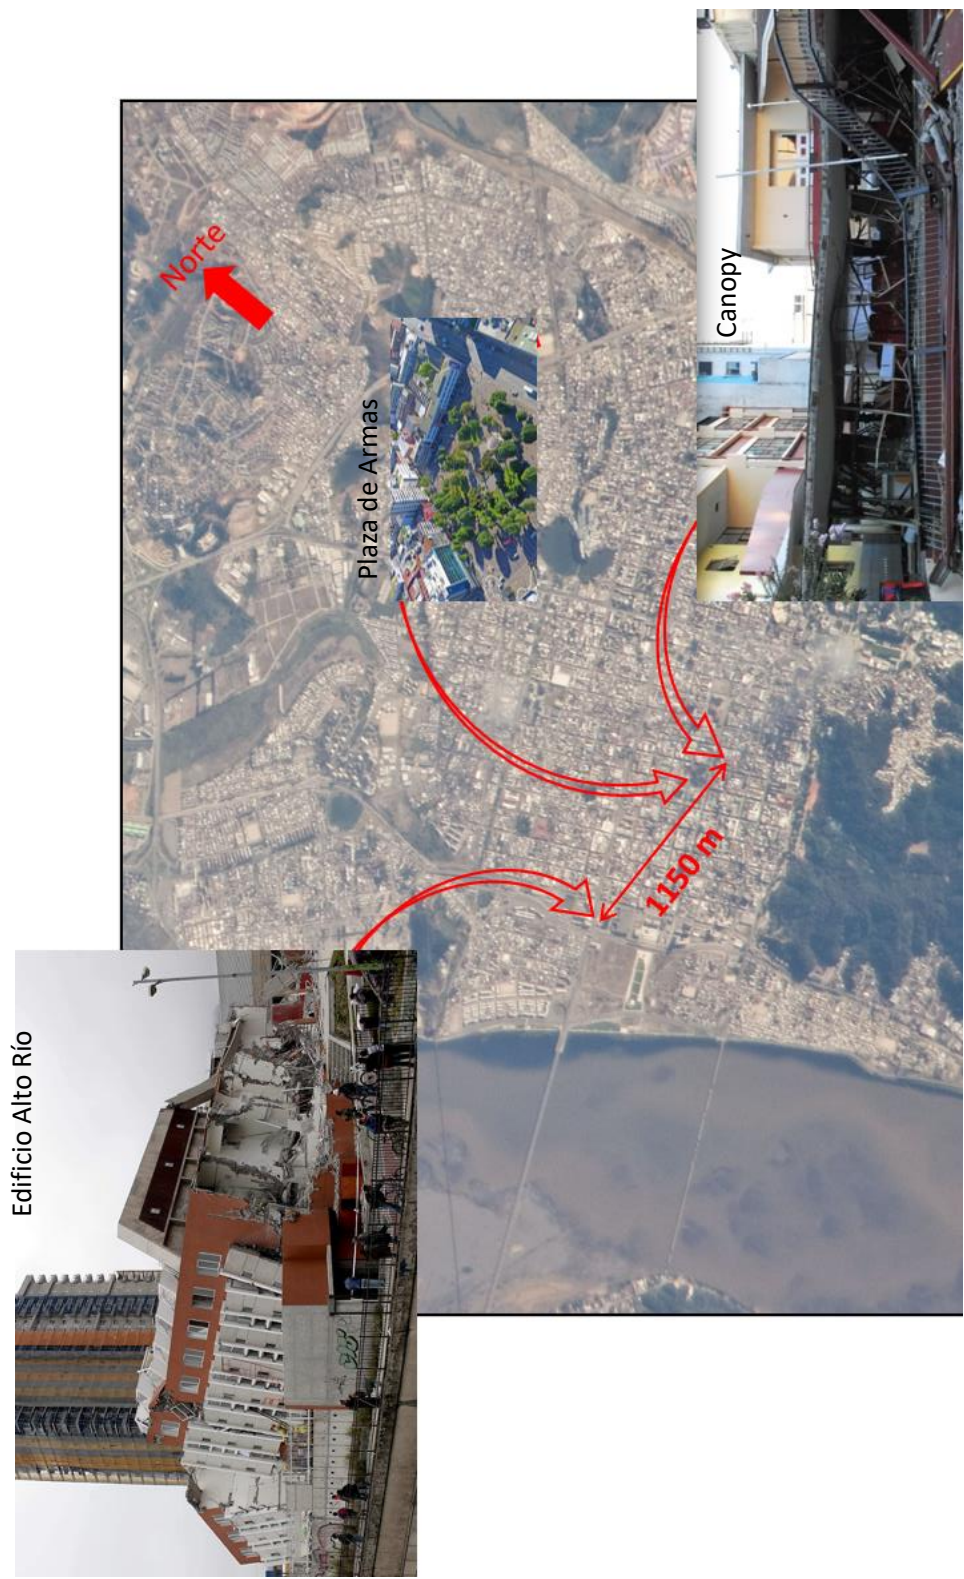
Planta de ubicación del canopy colapsado, Plaza de Armas y edificio colapsado Alto Río.
